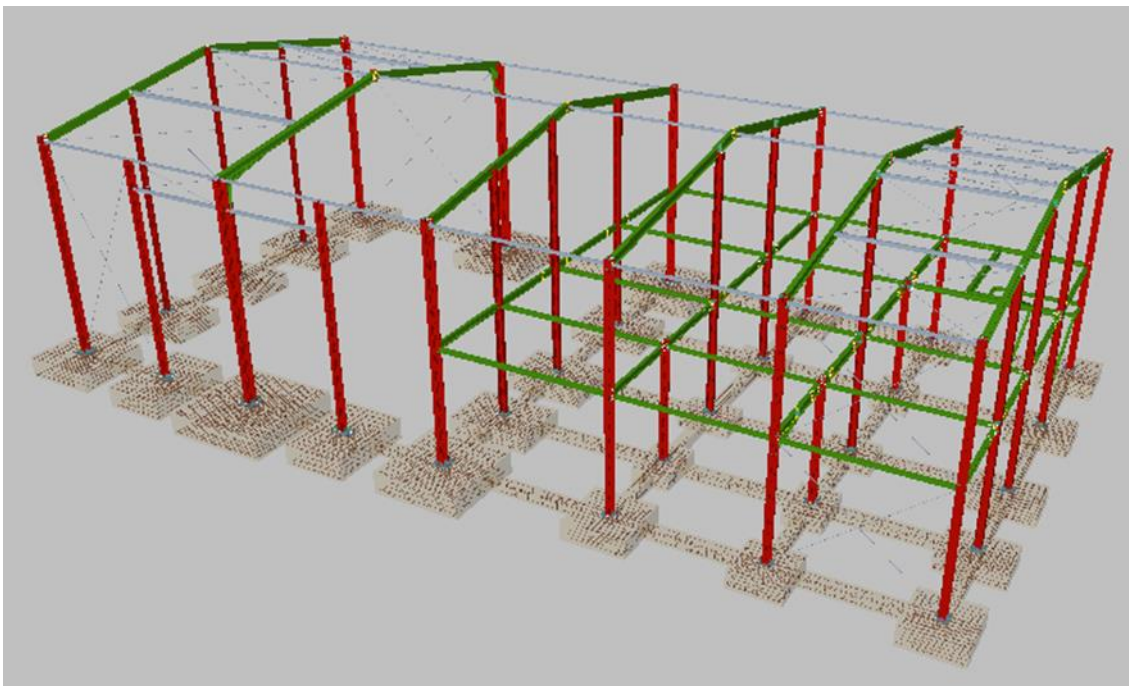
Estructura de la nave y cimentación en 3D (vista izquierda)
